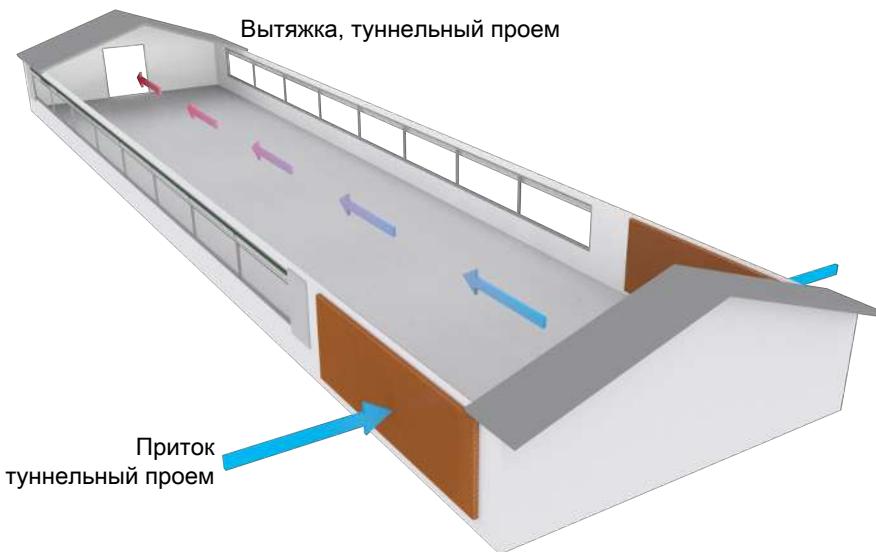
Пример помещения с естественной вентиляцией, применяемой вместе с туннельной вентиляцией, туннельная вентиляция.
